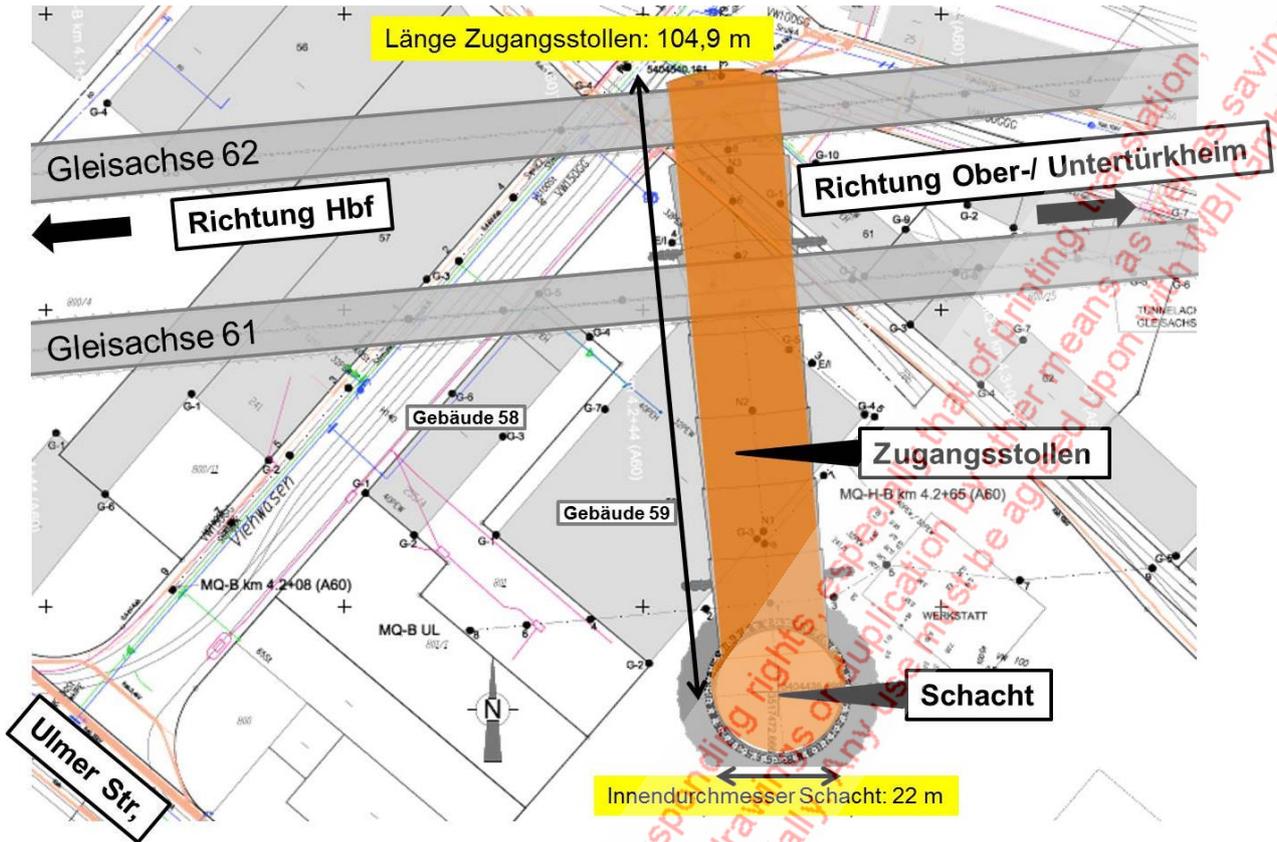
Zwischenangriff Ulmer Straße, Lageplan
